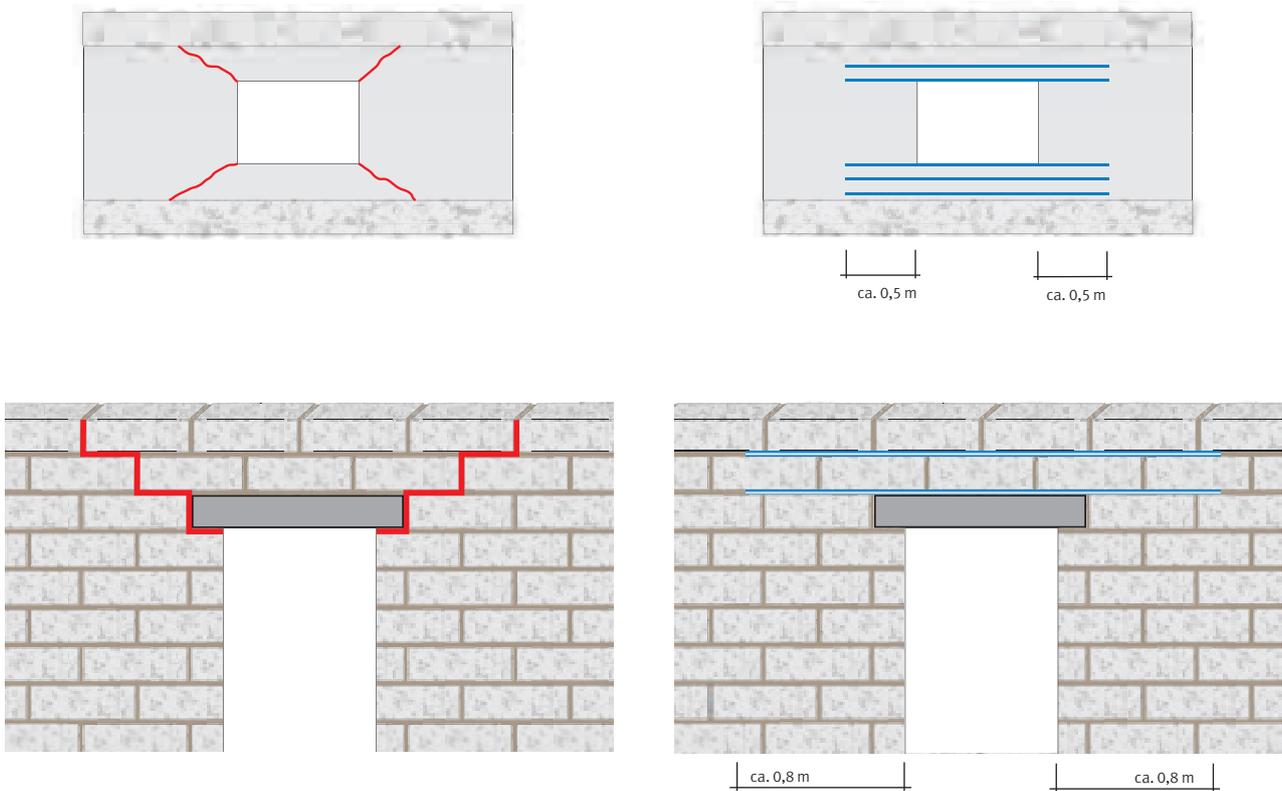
Konstruktive Lagerfugenbewehrung im Bereich von Öffnungen
